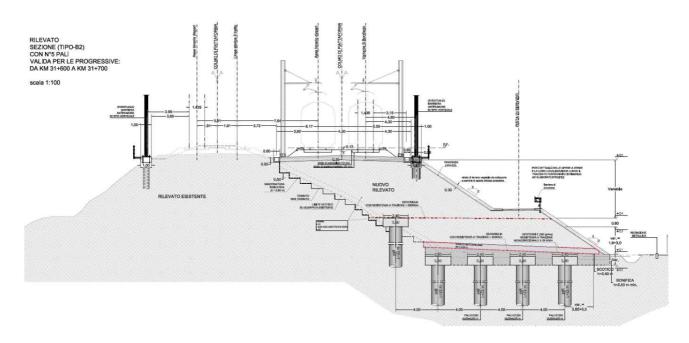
Progetto Definitivo - sezione tipo di intervento con rilevato in affiancamento alla linea storica
